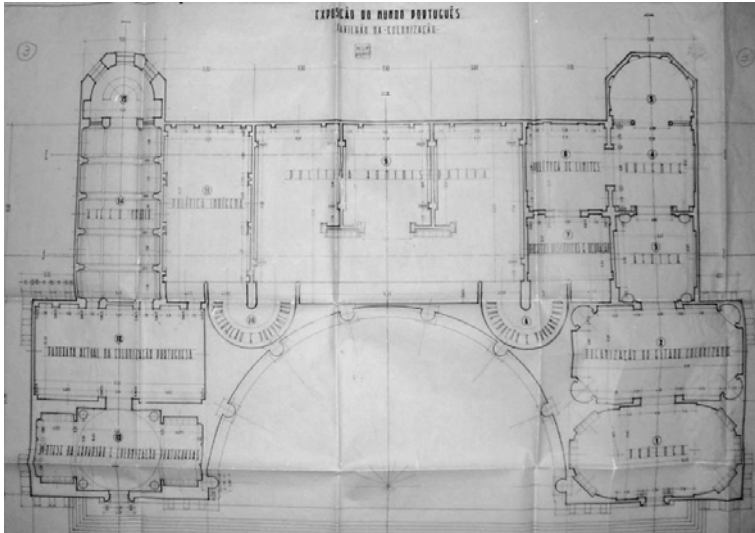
| PAVILHÃO DA COLONIZAÇÃO [PLANTA]
